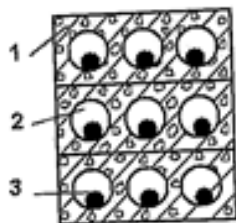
Эскиз прокладки кабелей в бетонный блок: 1 – бетонный блок; 2 – отверстие; 3 – силовой кабель
